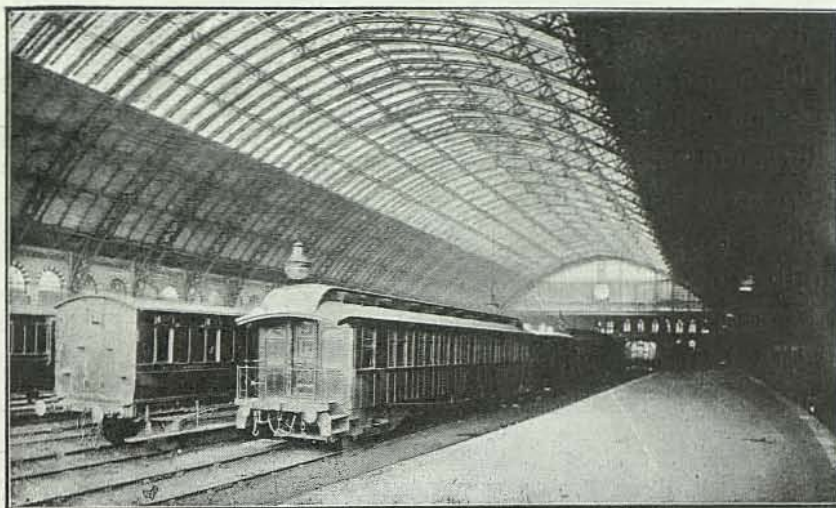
Uno de los primeros y notables ensayos de estructuras flexibles arqueadas sin tirante. — « St. Pancras Station », Londres
